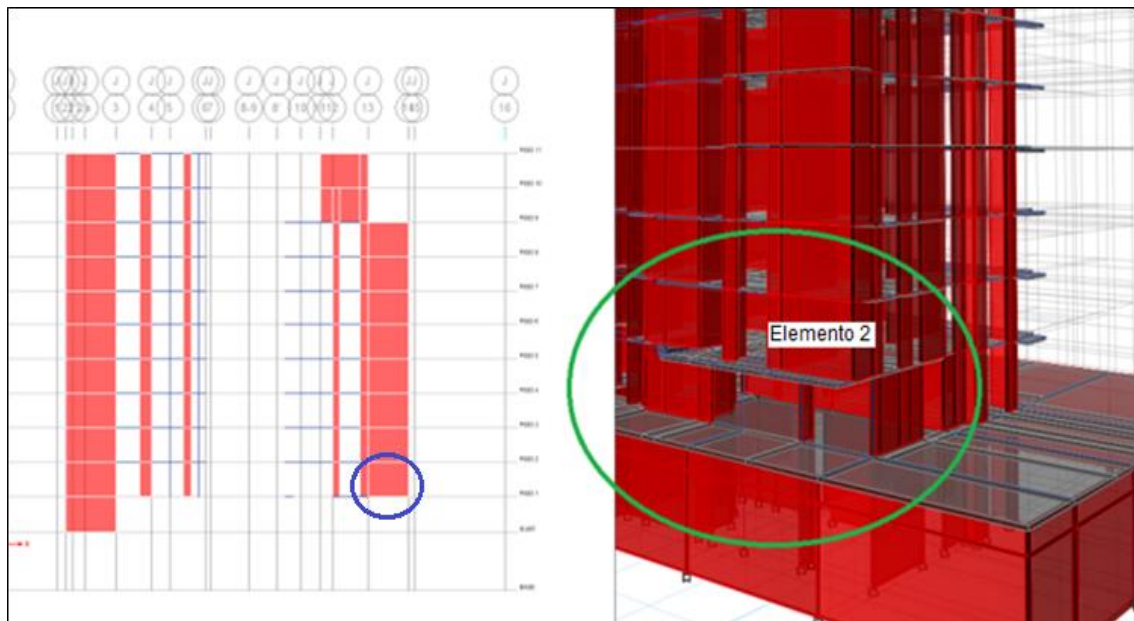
Elemento fuera del plano vertical, edificio T15 vista en elevación y en 3D (elemento 2)
